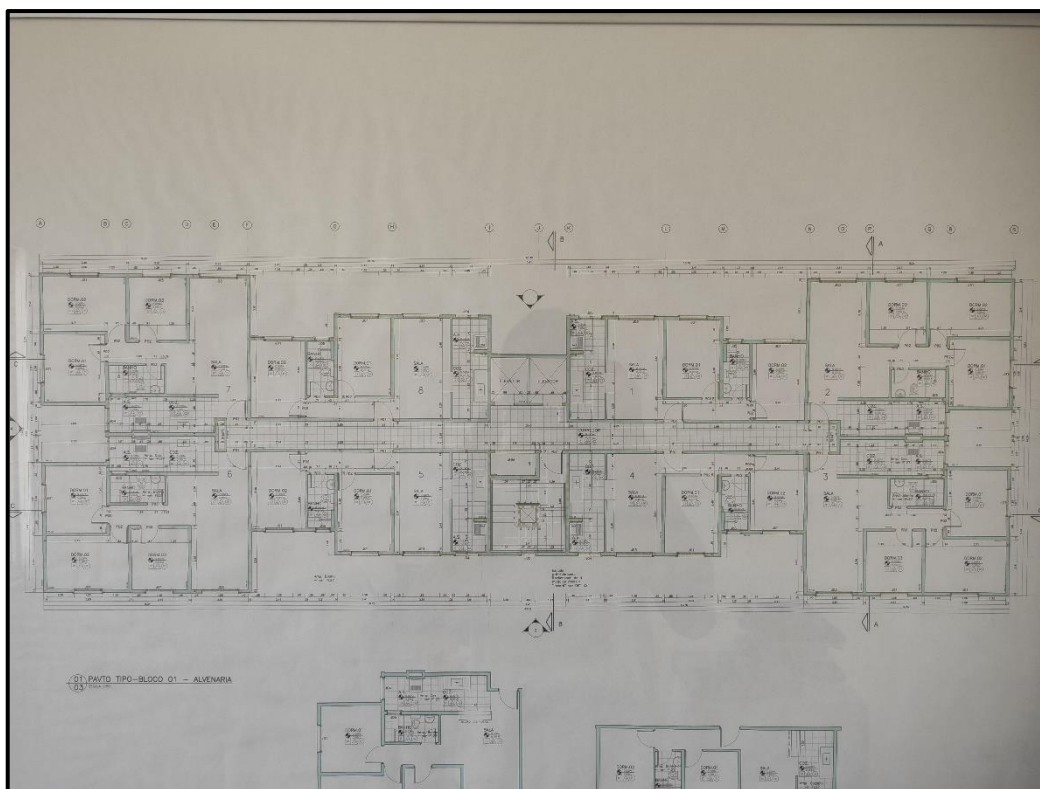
Planta layout da unidade privativa de número 95 – imóvel avaliando
